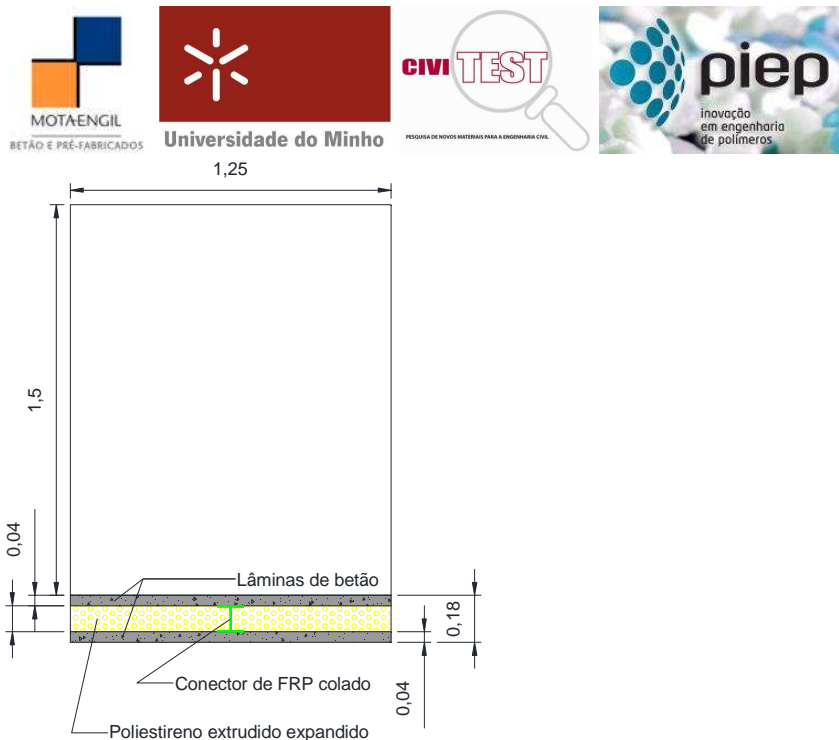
Geometria do painel sandwich com conectores perfil I colados de FRP e espessura da camada de betão de 40 mm (vista em planta, unidades em metros).
